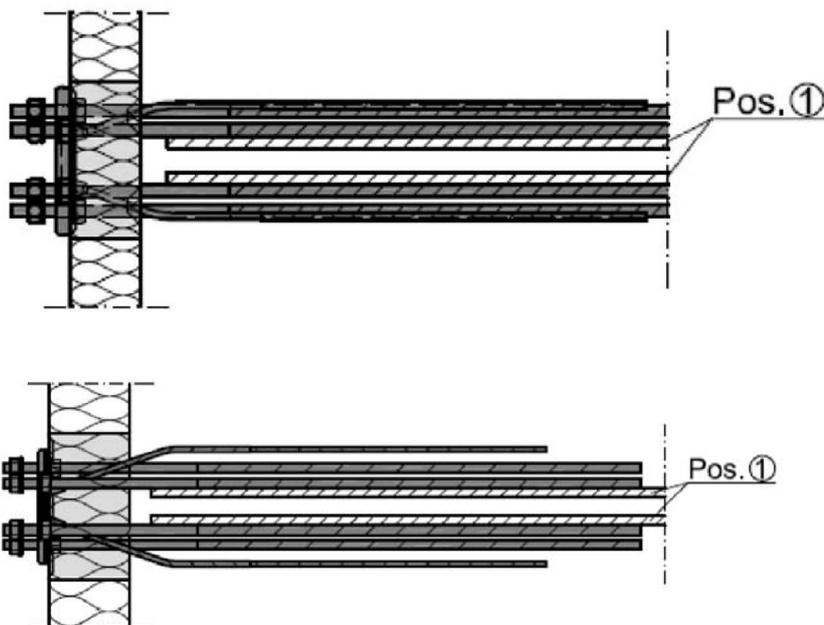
Draufsicht: Schöck Isokorb® T Typ SK-MM1-VV1 und XT Typ SK-MM1-VV1
